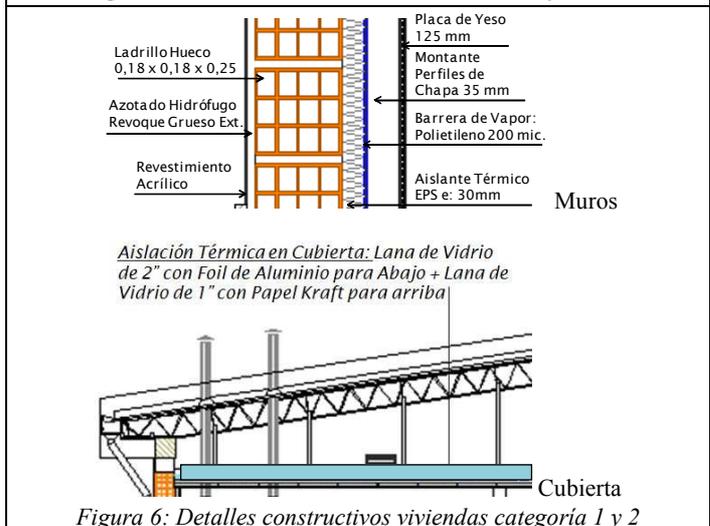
Detalles constructivos viviendas categoría 1 y 2
